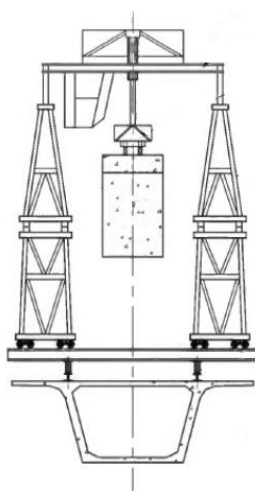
| 30 – Corte transversal de uma viga de lançamento [10]
